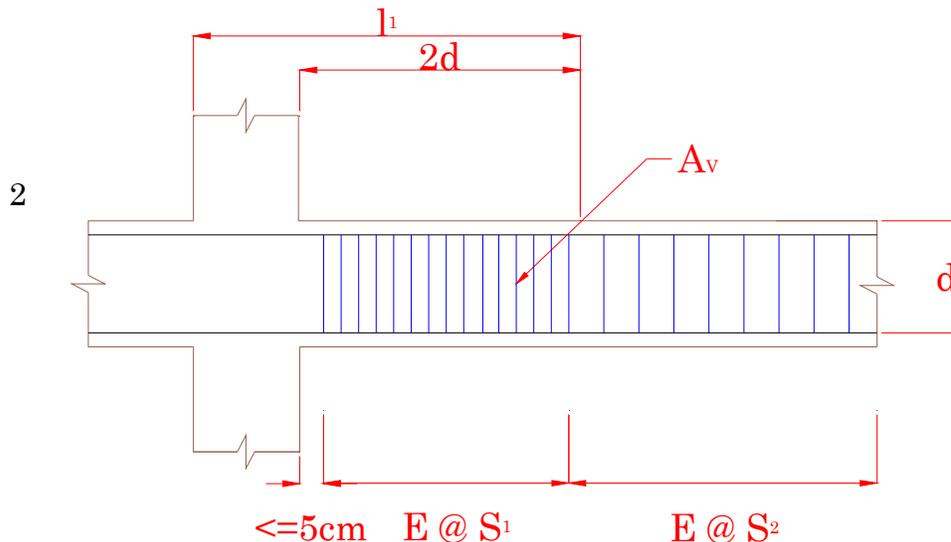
Requisitos para el Refuerzo Transversal de Vigas de Marcos de Concreto
